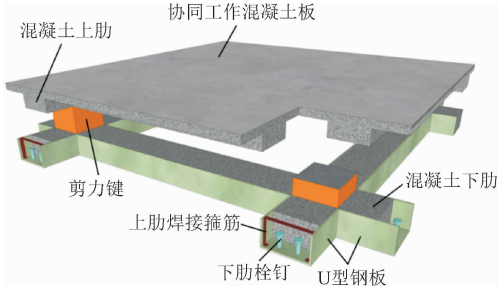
U 型钢-混凝土组合空腹夹层板^[10]
